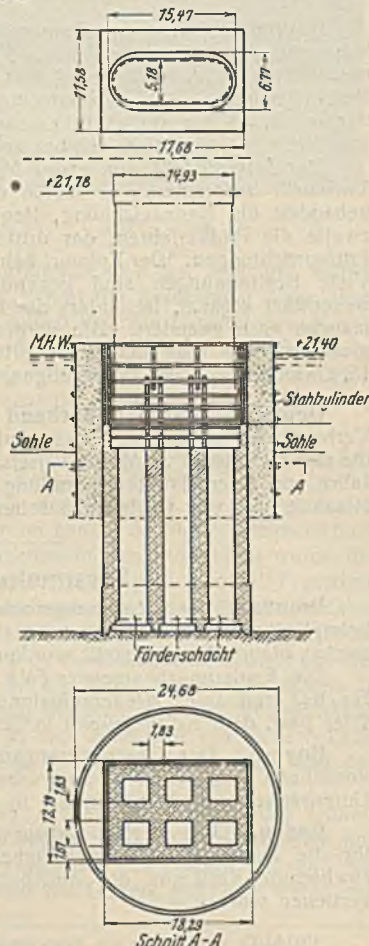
Grundriß und Schnitt durch einen im Stahlzylinder gegründeten Pfeiler.
